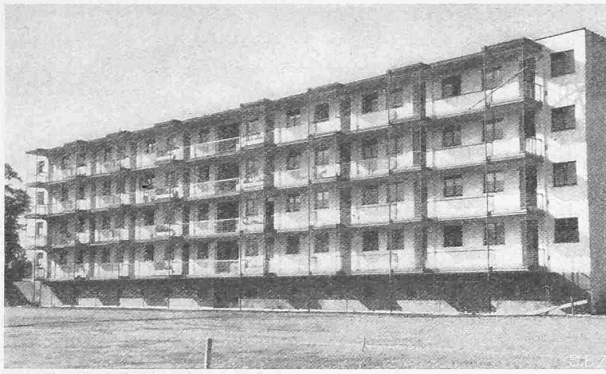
bis 15. Gruppe 6: Viergeschossiges Wohngebäude mit Aussengang.
